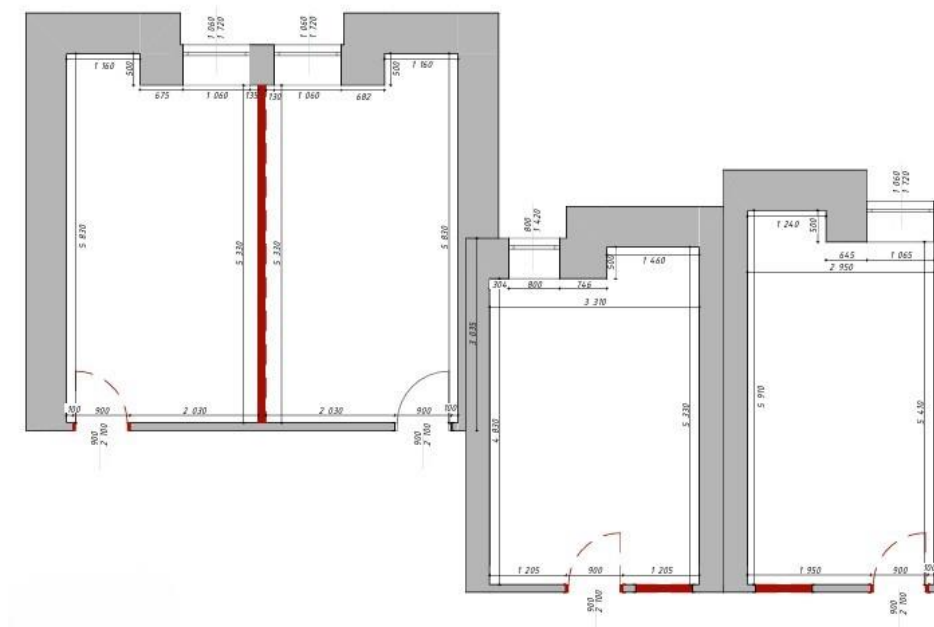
Схема плану демонтажу для усіх кімнат
